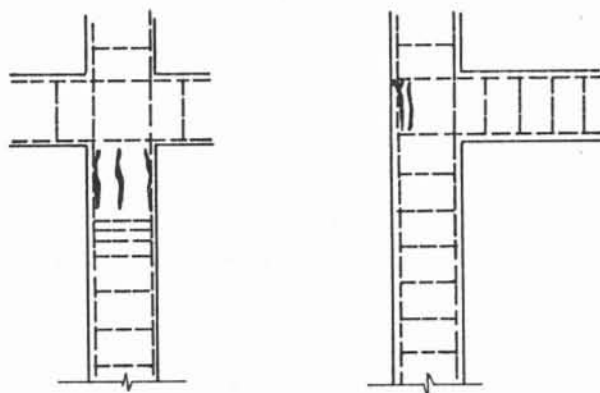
Rompimento de pilares por falta de estribos.
